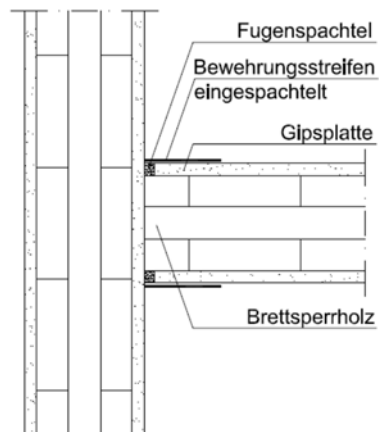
Anschlussdetail einer bekleideten Brettsper Holzwand in Anlehnung an [ÖNORM B 2320]
